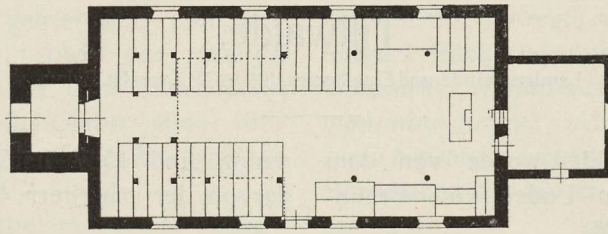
Kl. Tromnau. Grundriß der Kirche.
